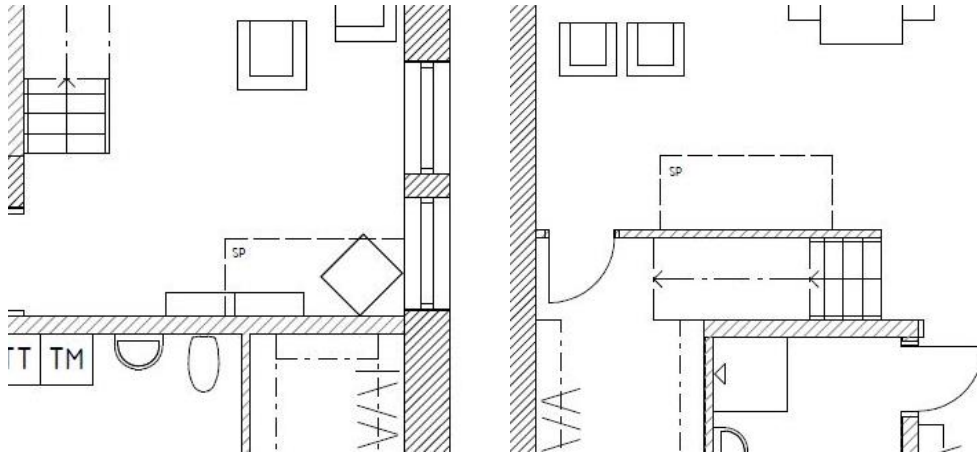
Planritning, byggnad 2, plan 1. Producerad i Revit.
